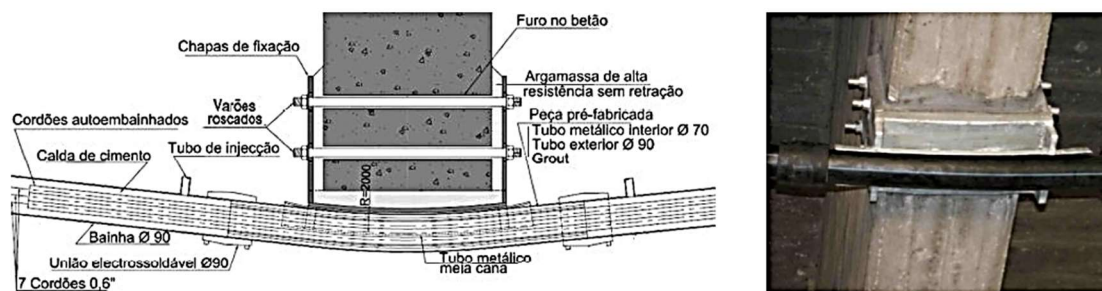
Desviador de aço ligado a uma estrutura de betão armado [40]
